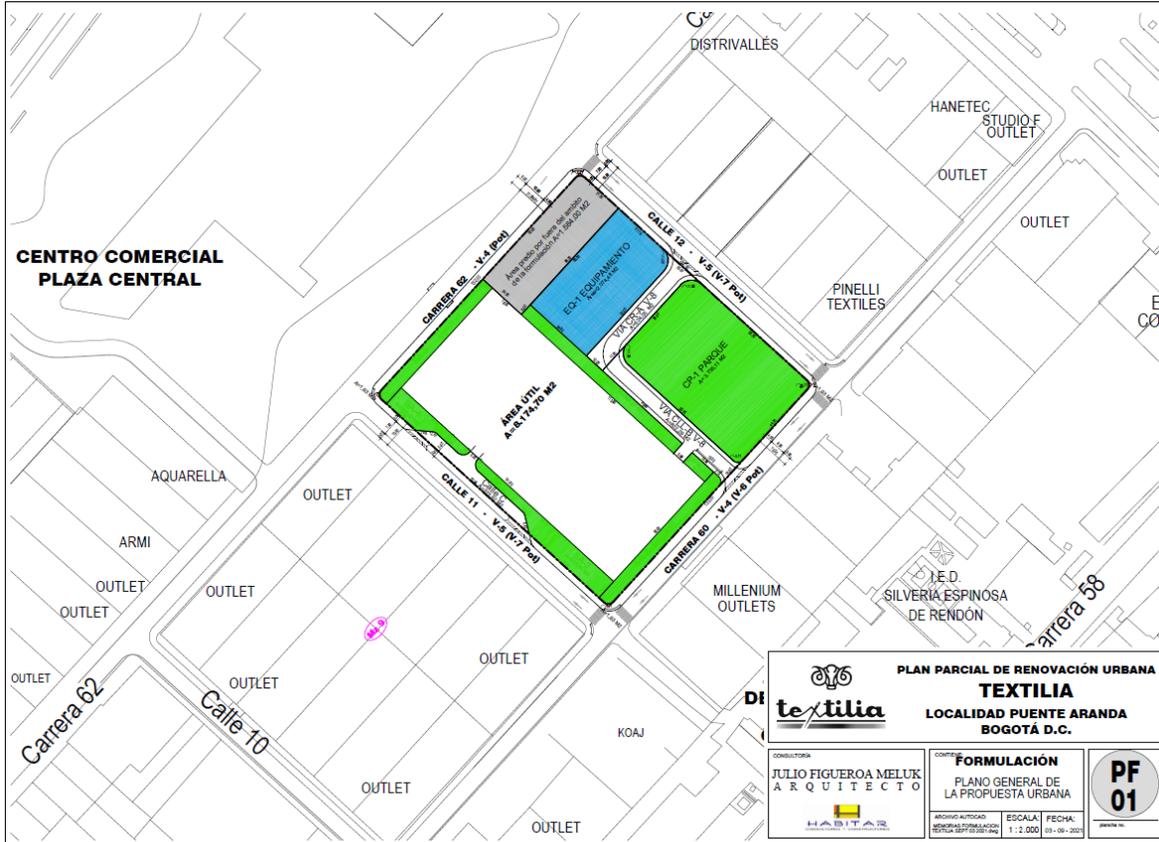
Plano PF-01. Plano General de la Propuesta Urbana
